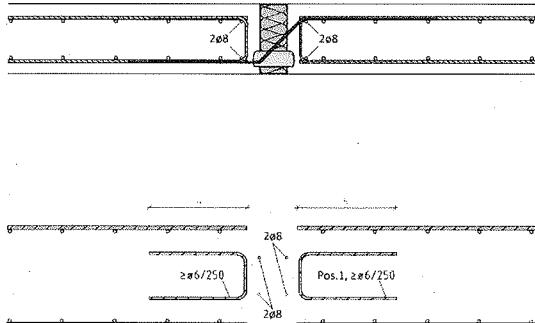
Bewehrungsführung Q bei indirekter Lagerung und deckenseitig geraden Querkraftstäben
